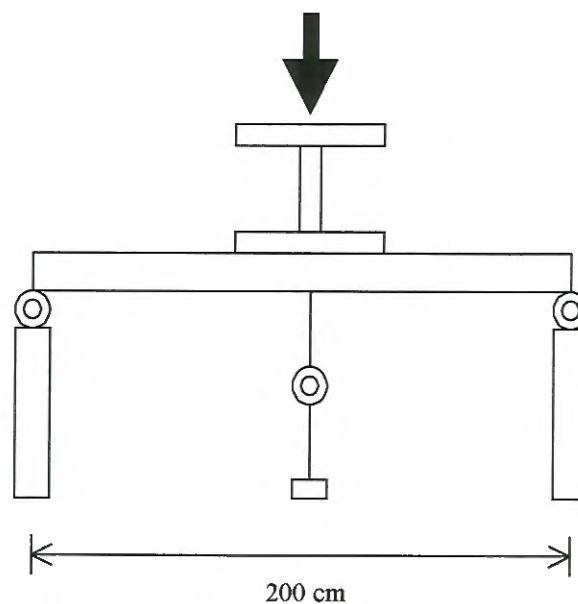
Sistema de carregamento para painéis horizontais.
